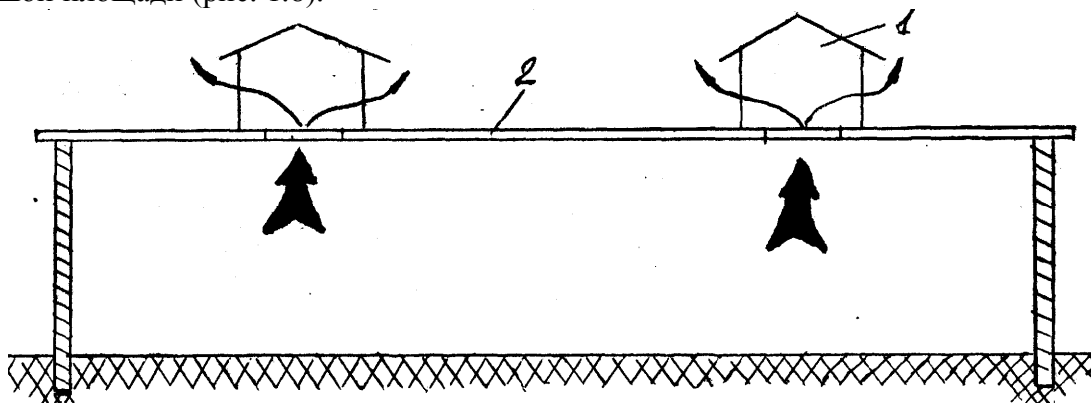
Устройство дымовых люков в покрытиях бесфонарных зданий большой площади:
